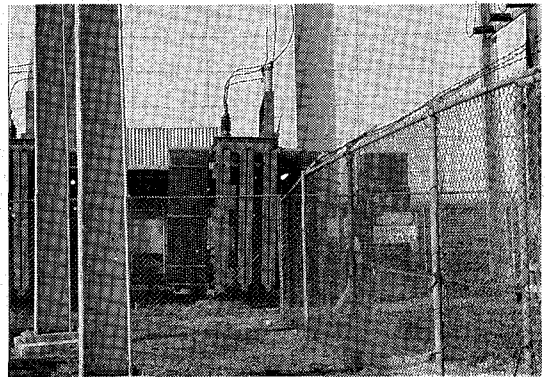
基礎から傾いた Cabras 発電所の屋外変圧器
